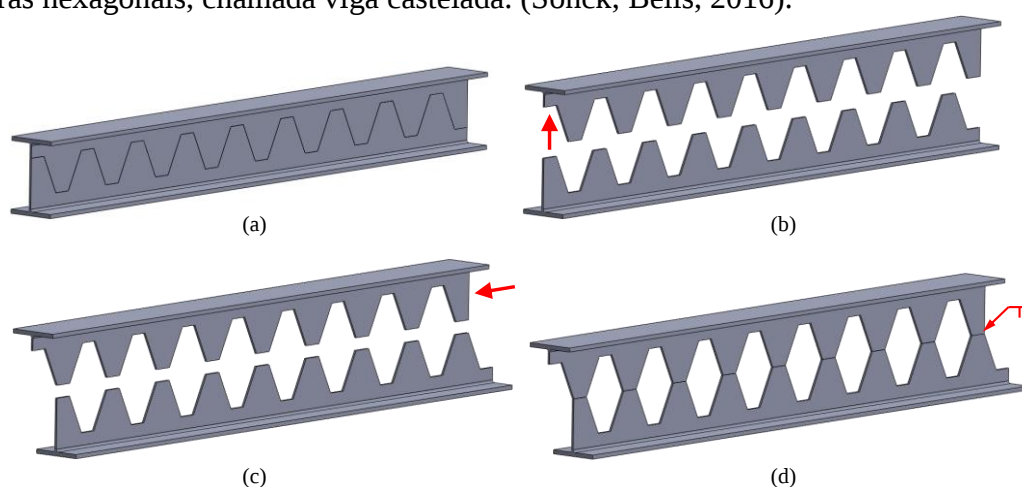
Esquema do corte e montagem de vigas alveolares casteladas
